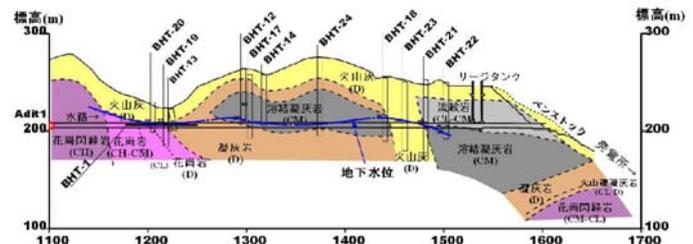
第一発電所導水路 Adit 1～発電所間の地質縦断面図 (代替ルート案 Case 1 沿い)
